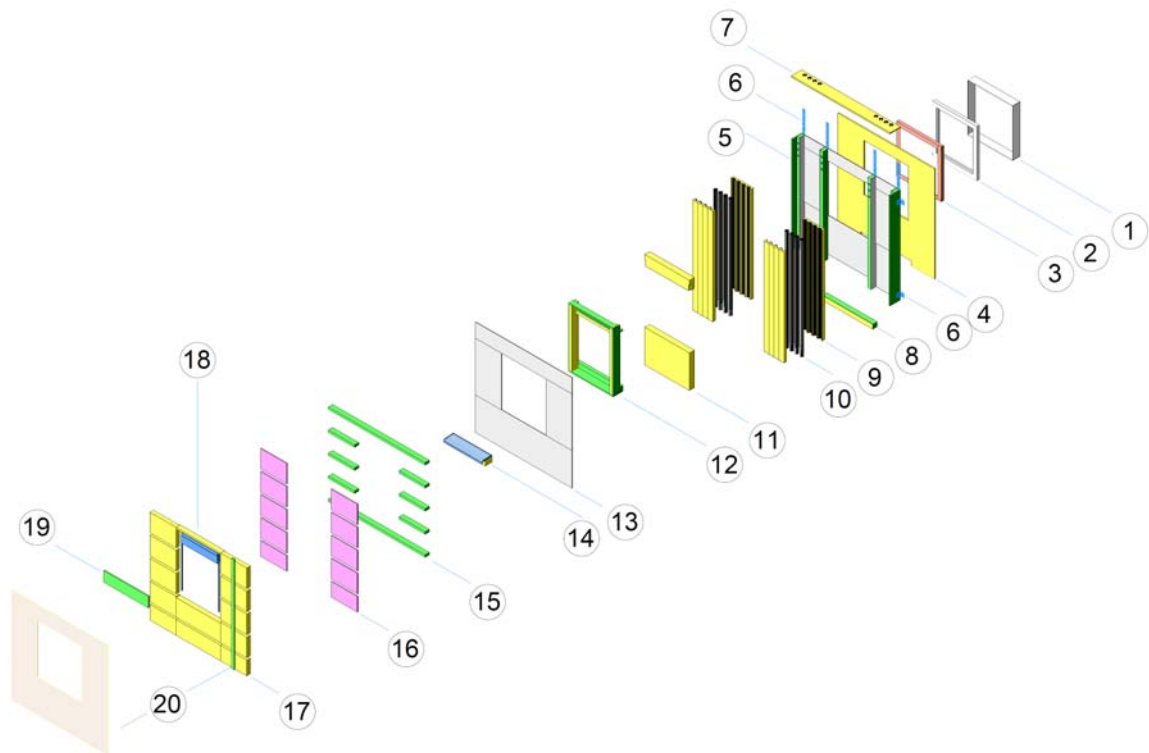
Explosionszeichnung der Einzelbauteile des Basismoduls F4.1
